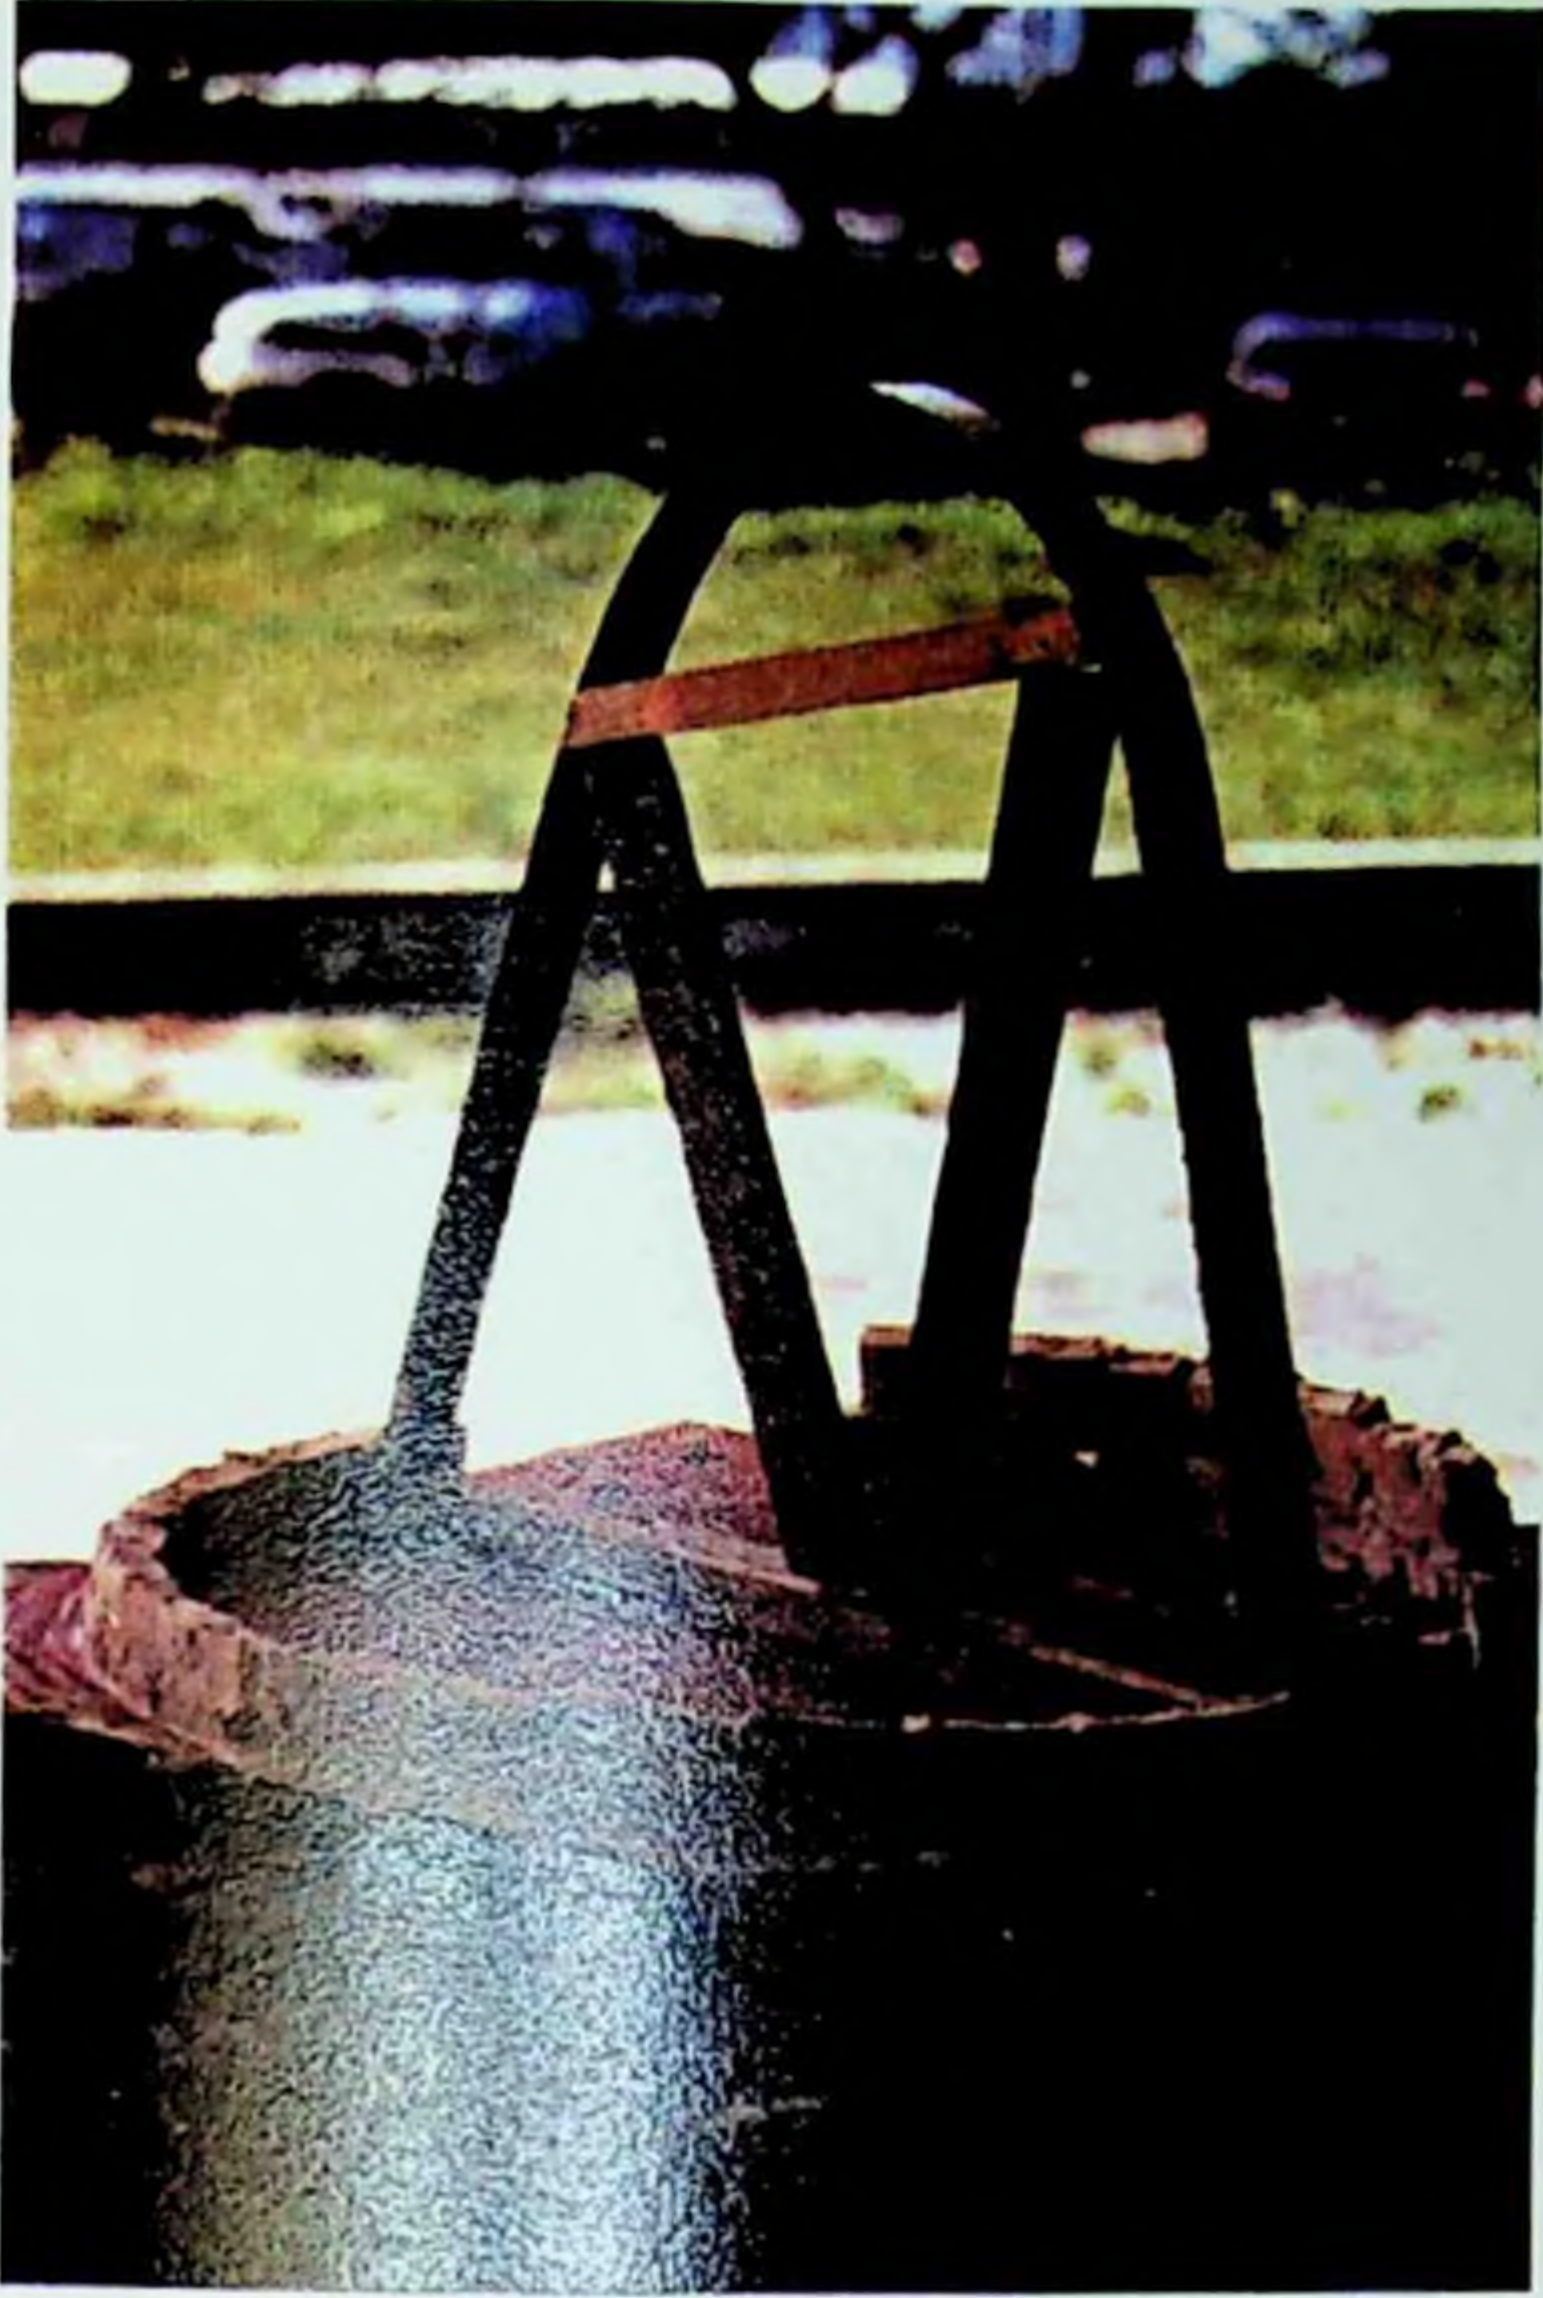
Outra equipe, outra idéia, outro gabarito.
